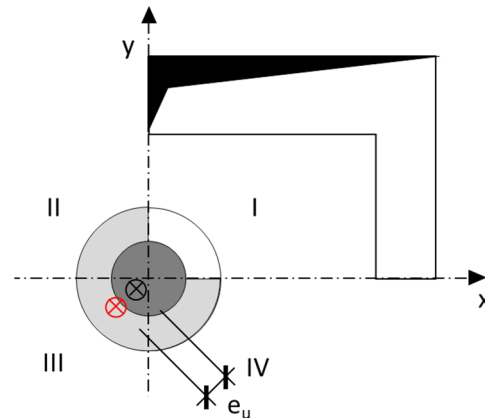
Beispiel zur k_e -Wertberechnung - Grundriss der Situation
